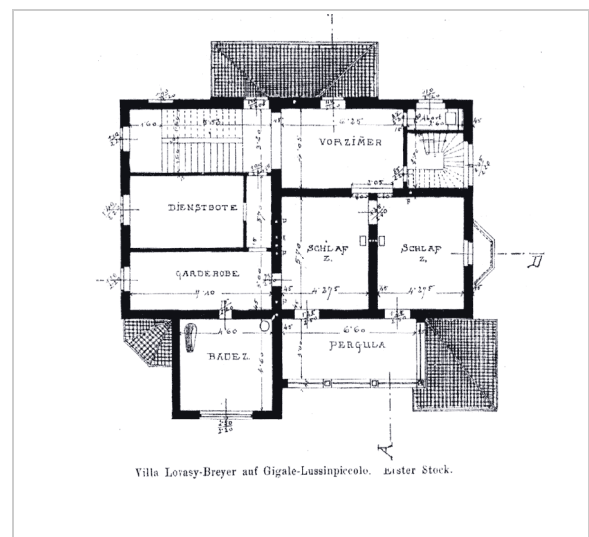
Grundriss des Obergeschoßes.
